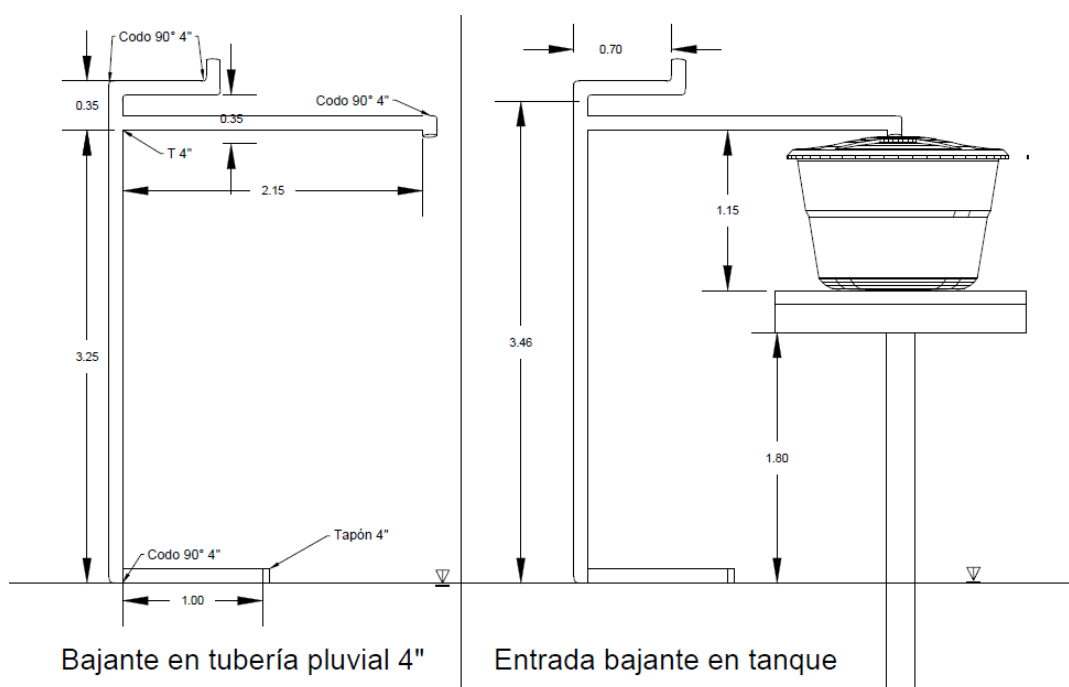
Bajante y detalles desde cubierta a tanque receptor.
